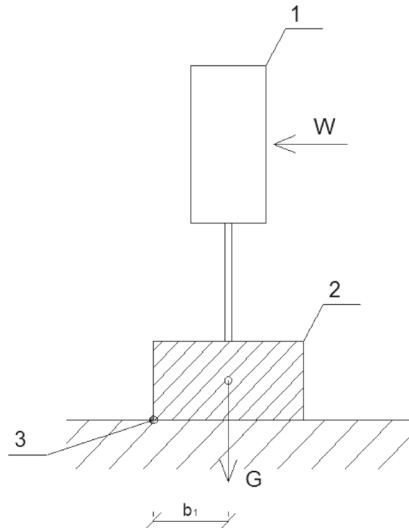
Схема расчета рекламной конструкции на опрокидывание:
